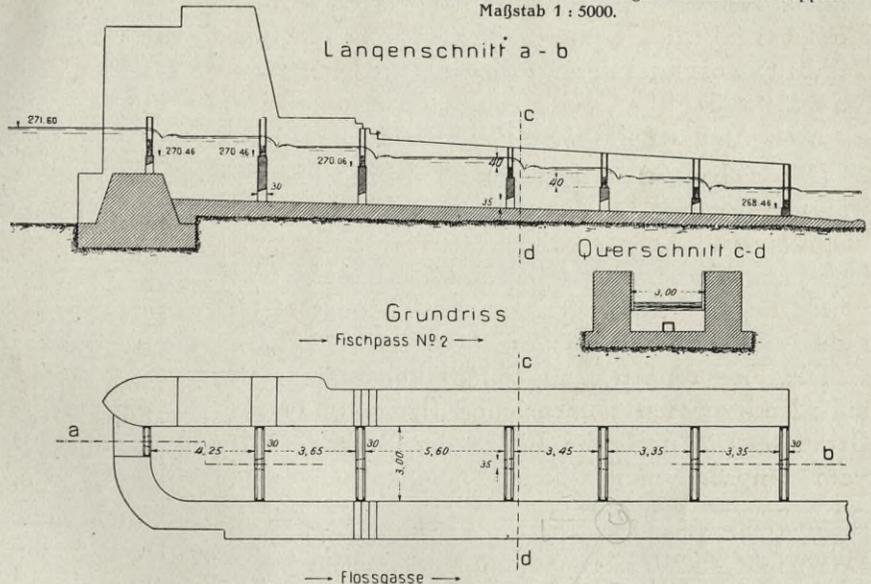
Stauwehr des Elektrizitätswerkes Rheinfelden. Grundriss und Längenschnitt durch die Fischtreppe 2 b. Maßstab 1 : 300.
